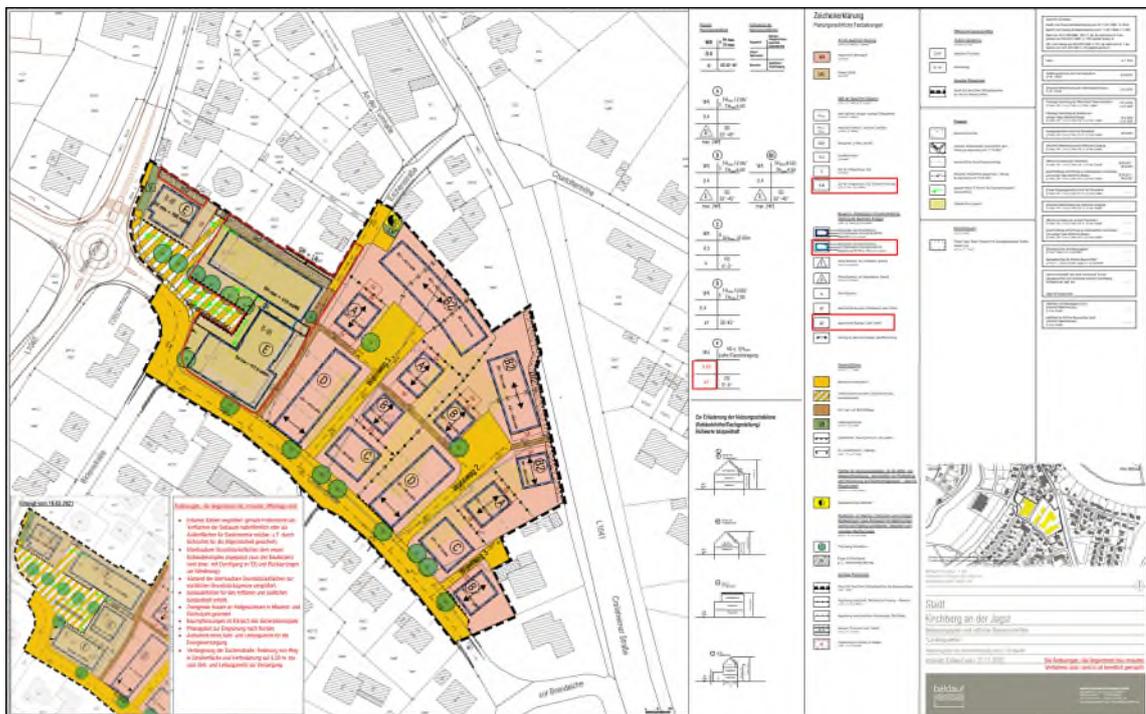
Übersichtslageplan mit Lage des Plangebietes [13]
